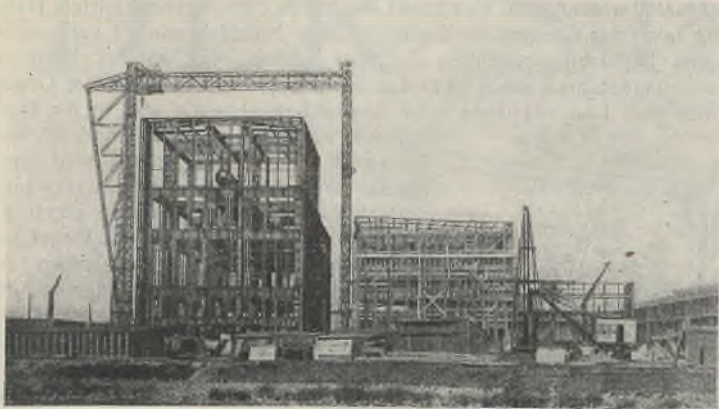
Montagezustand des Kessel- und Maschinenhauses am 6. Oktober 1929.
